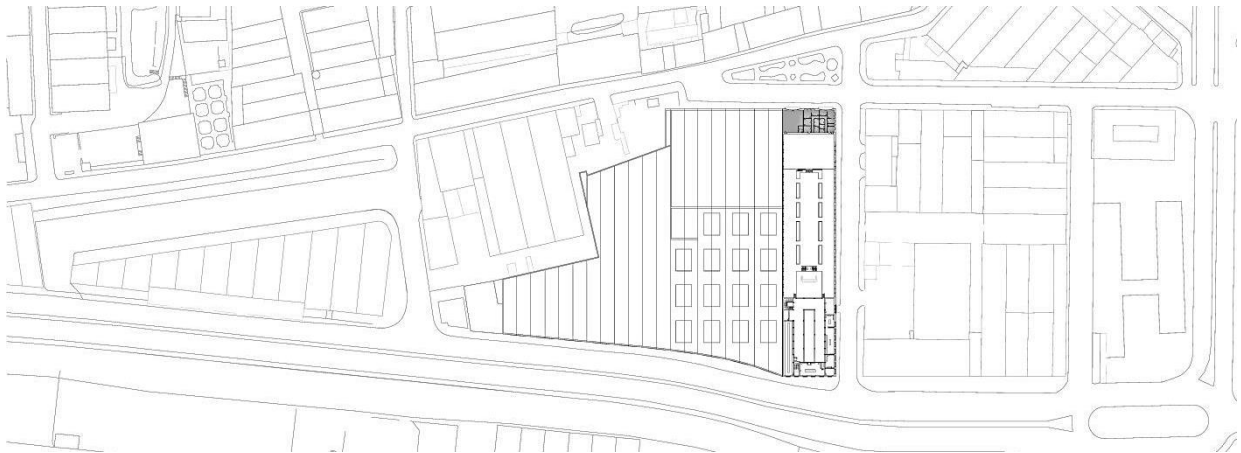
Planta de levantamento fotográfico piso 1 – Armazém 1.
